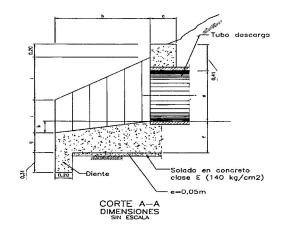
Detalle de dimensiones de la estructura de cabezal en concreto para alcantarilla de drenaje<sup>12</sup>.
